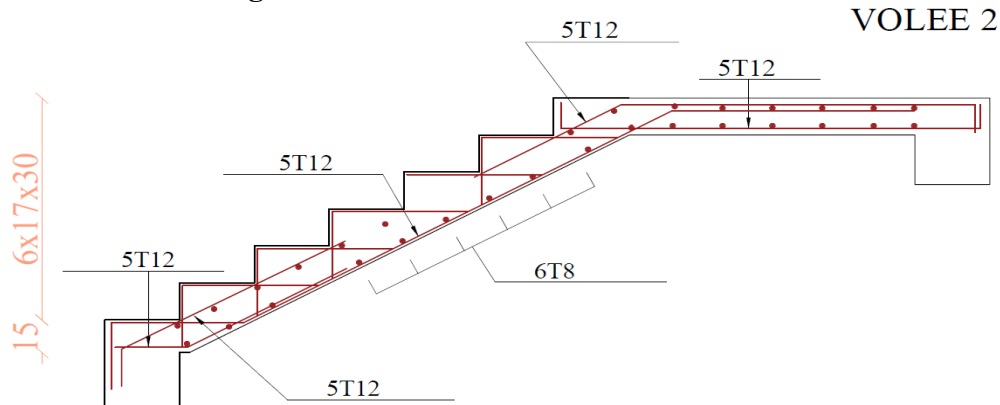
Schéma de ferrailage du 2^{ème} Type d'escalier.
